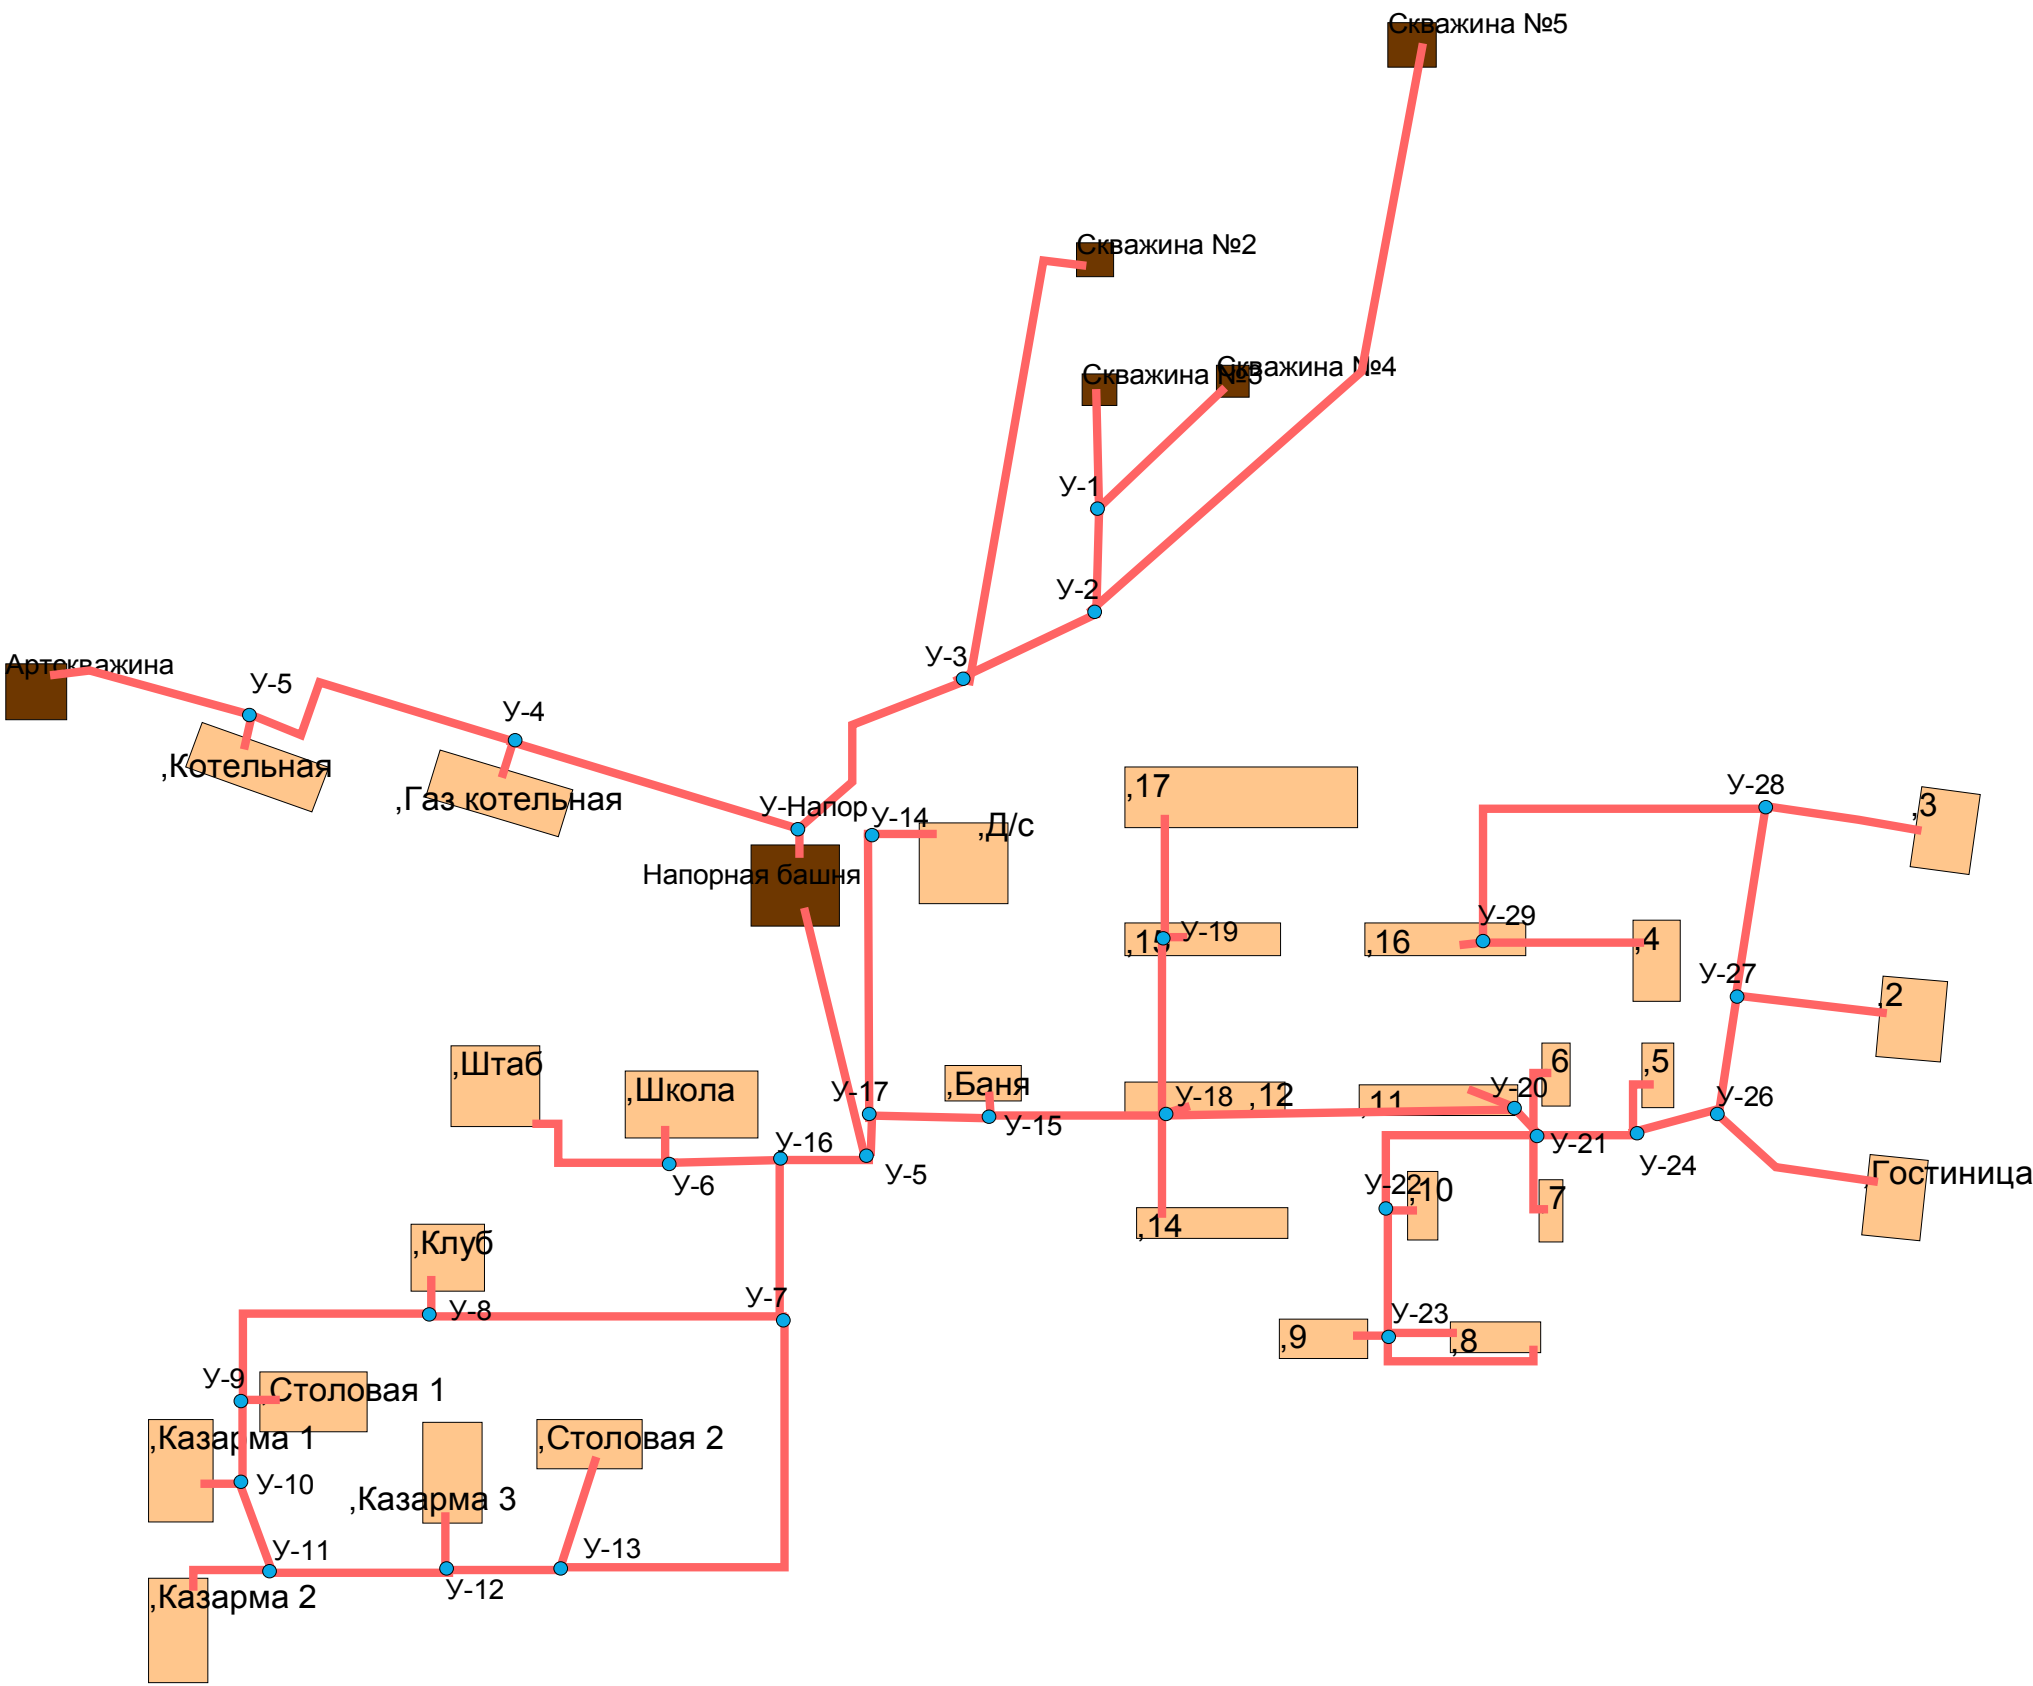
Схема водопроводных сетей с. Туношна-городок 26
